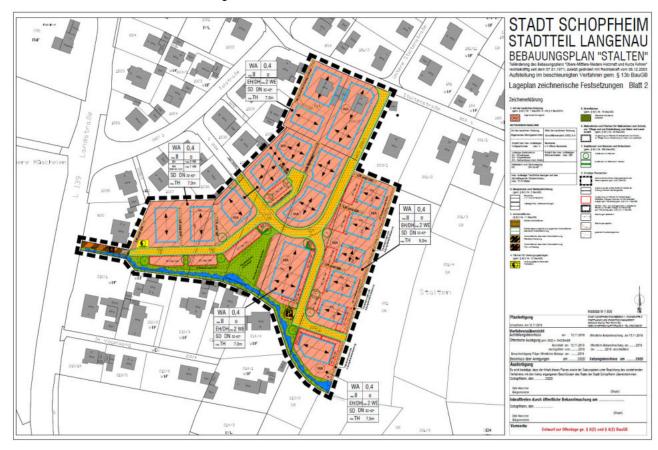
Bebauungsplan "Stalten" (Quelle: Stadt Schopfheim)
